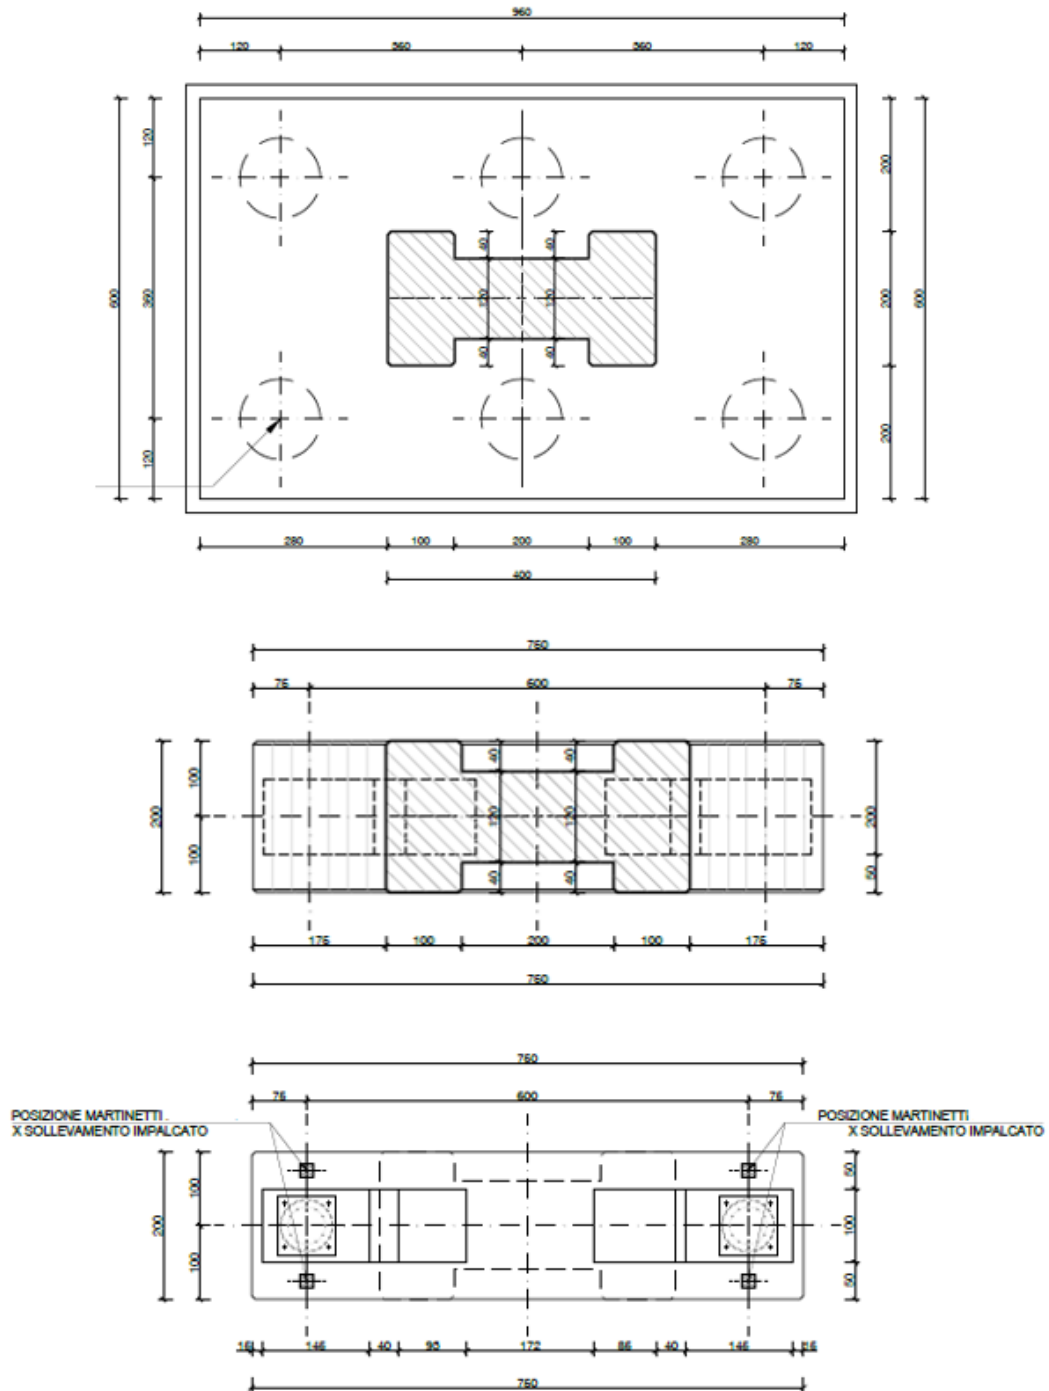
Viste in pianta della pila – quota spiccatto; quota pulvino vista inferiore; quota pulvino vista superiore
